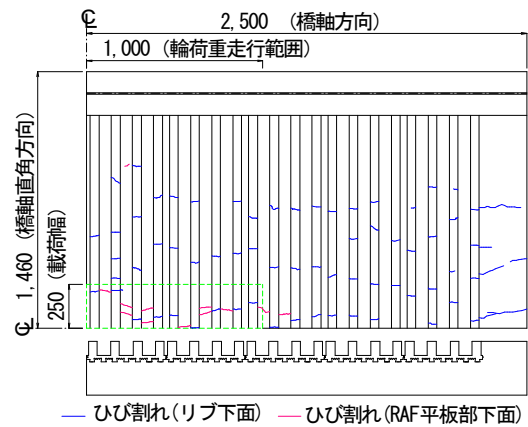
下面のひび割れの発生状況 (1/4部分を示す。)
